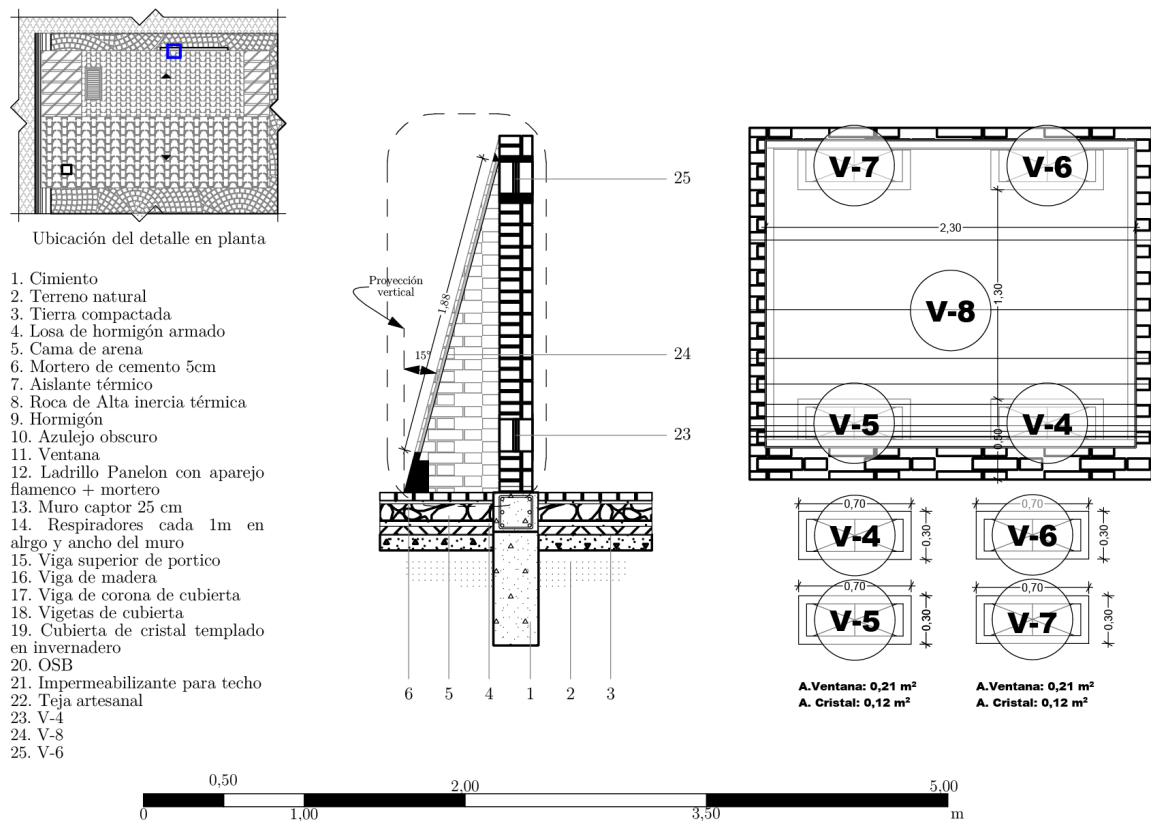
Detalle constructivo de Muro Trombe del diseño alternativo que recoge las recomendaciones de Guzmán (2016).
